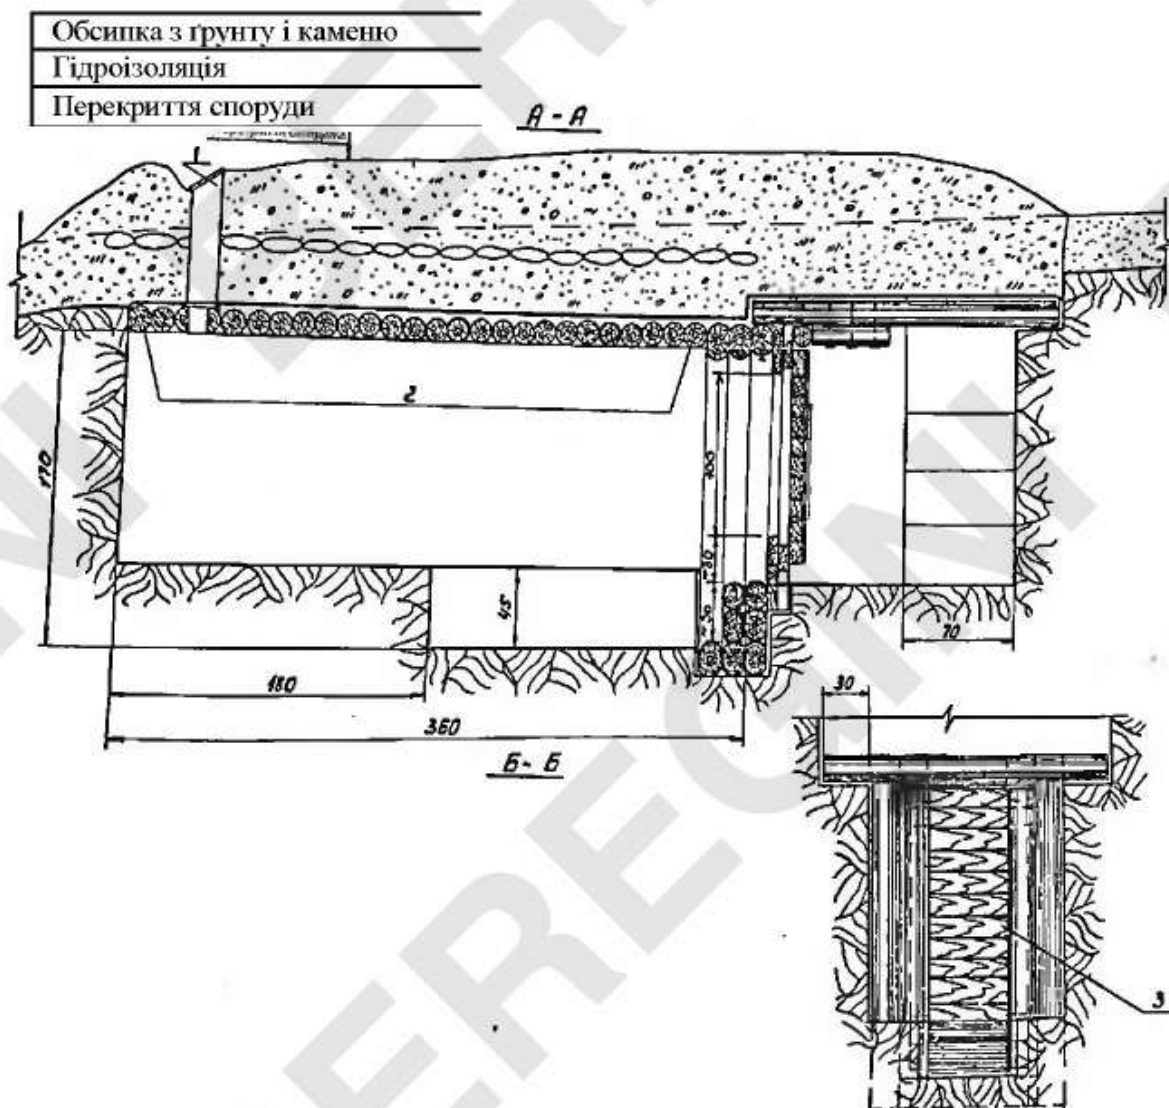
Бліндаж, обладнаний у скальному ґрунті (план):
